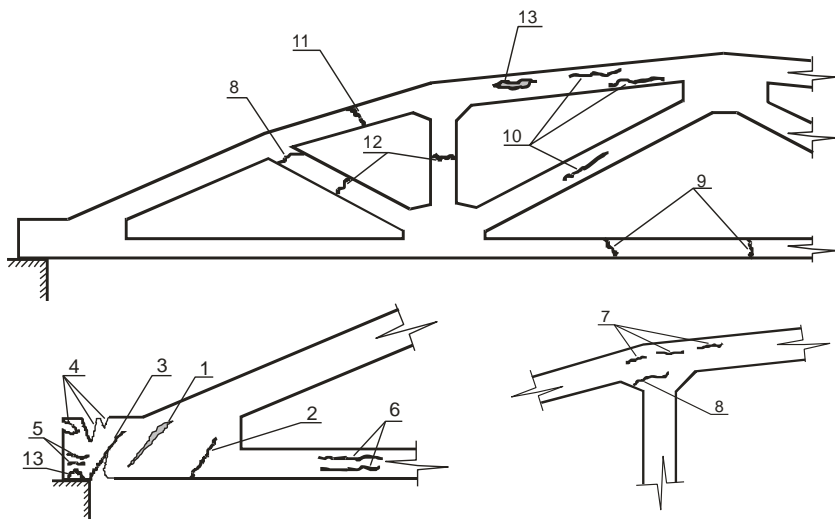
Картина трещинообразования в стропильной ферме:
